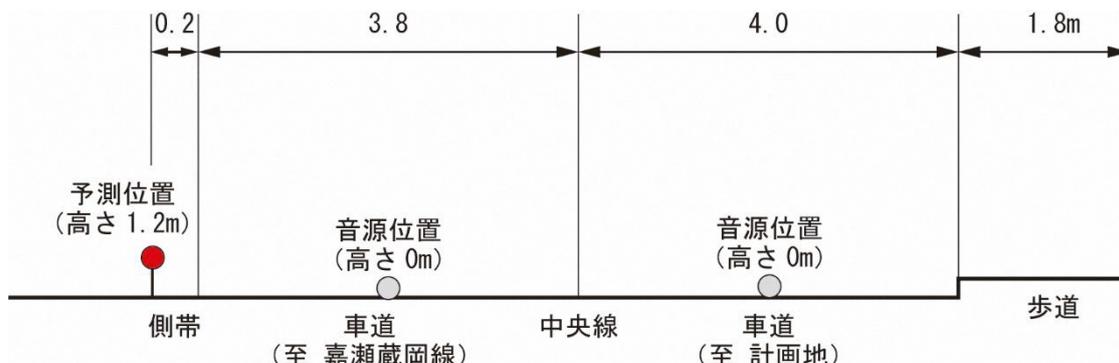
(1) 道路断面図 (No.1: 南 6-79 号線沿道)
